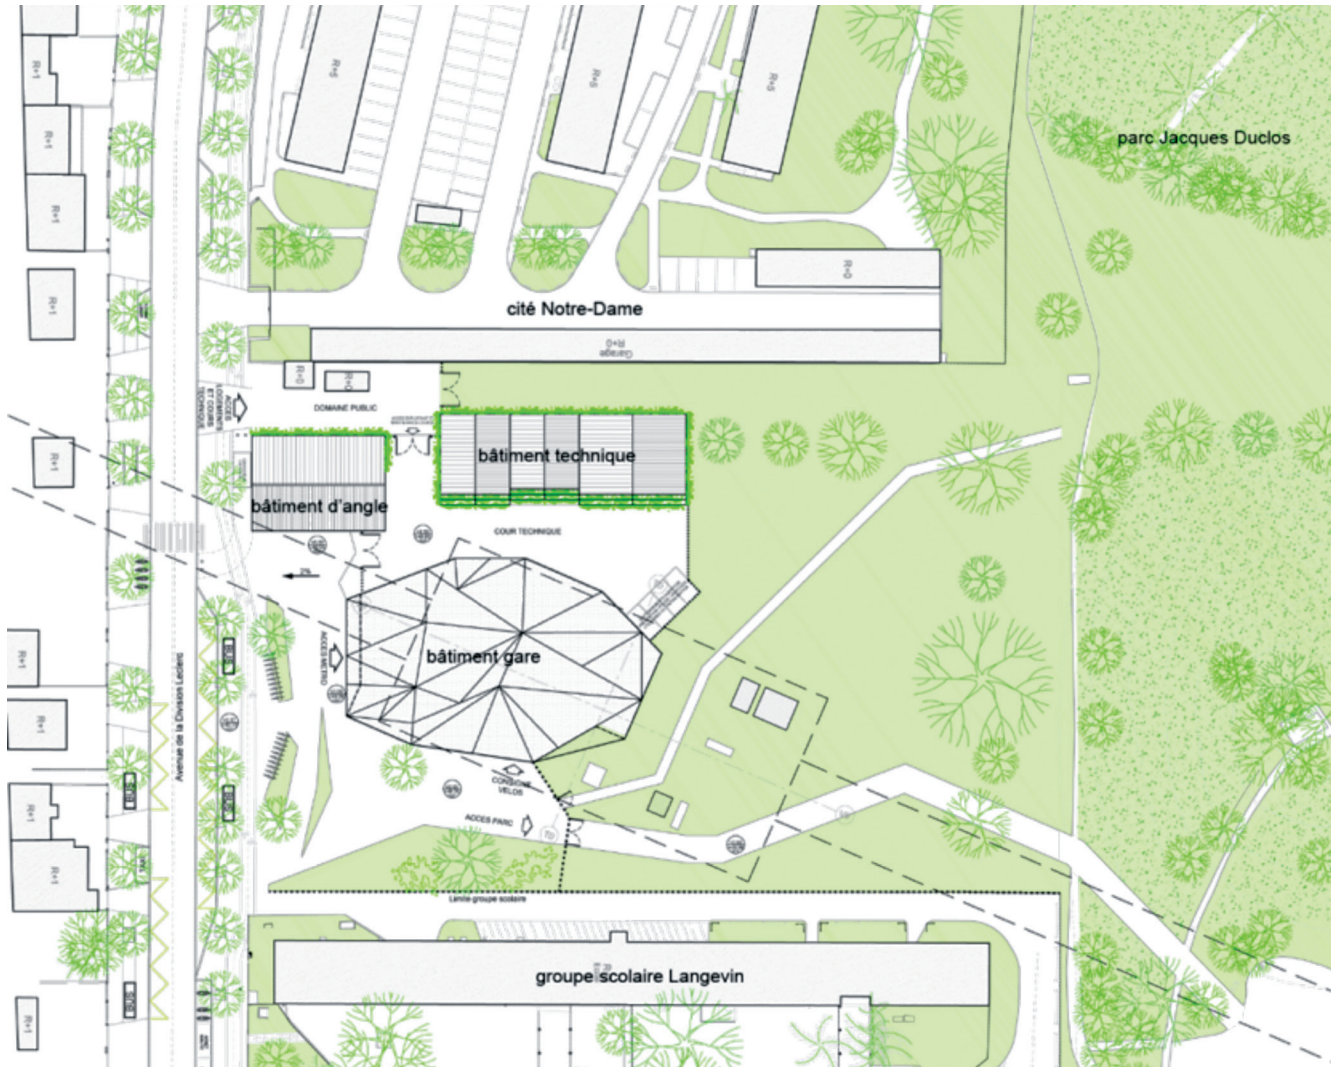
Plan d'implantation du projet de la Gare au sein du contexte existant
